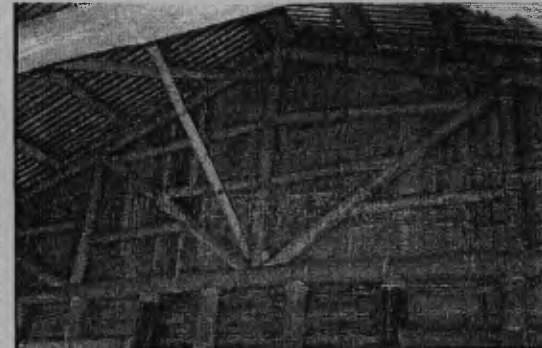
TIJERAS DE BAMBU TIPO HOWE
